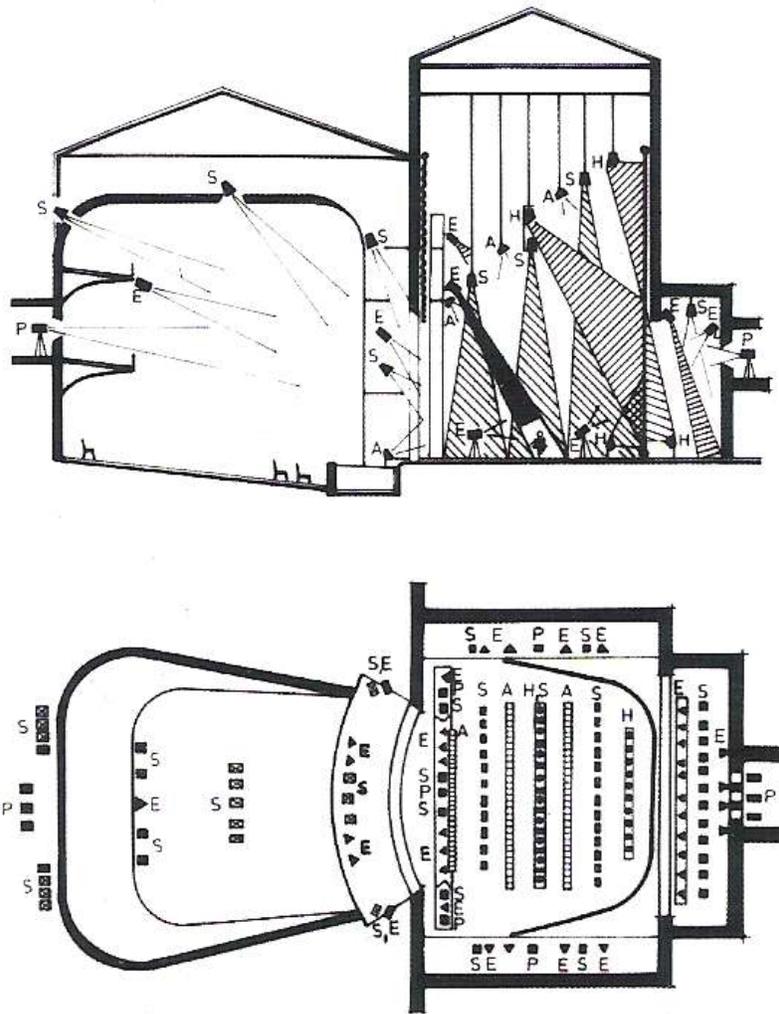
Grundriss und Längsschnitt eines Theaters
